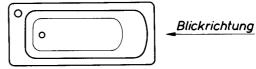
Badewanne mit Rechtsbohrung für Zuflußarmatur (Wanne mit Rechtsbohrung)
